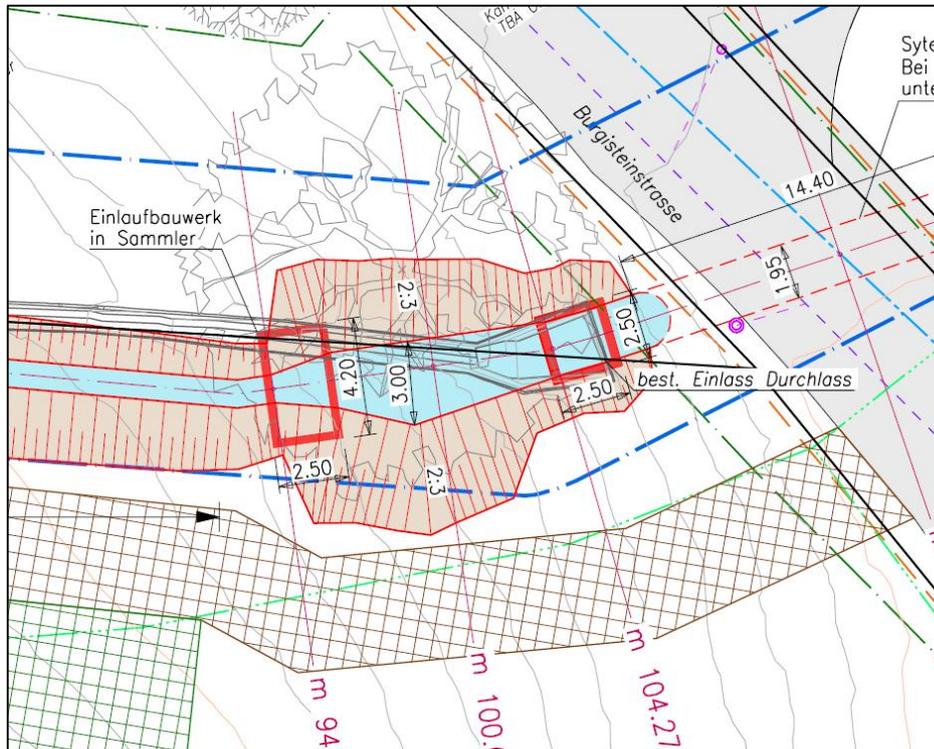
AUSBAU GESCHIEBESAMMLER, AUSSCHNITT SITUATIONSPLAN
